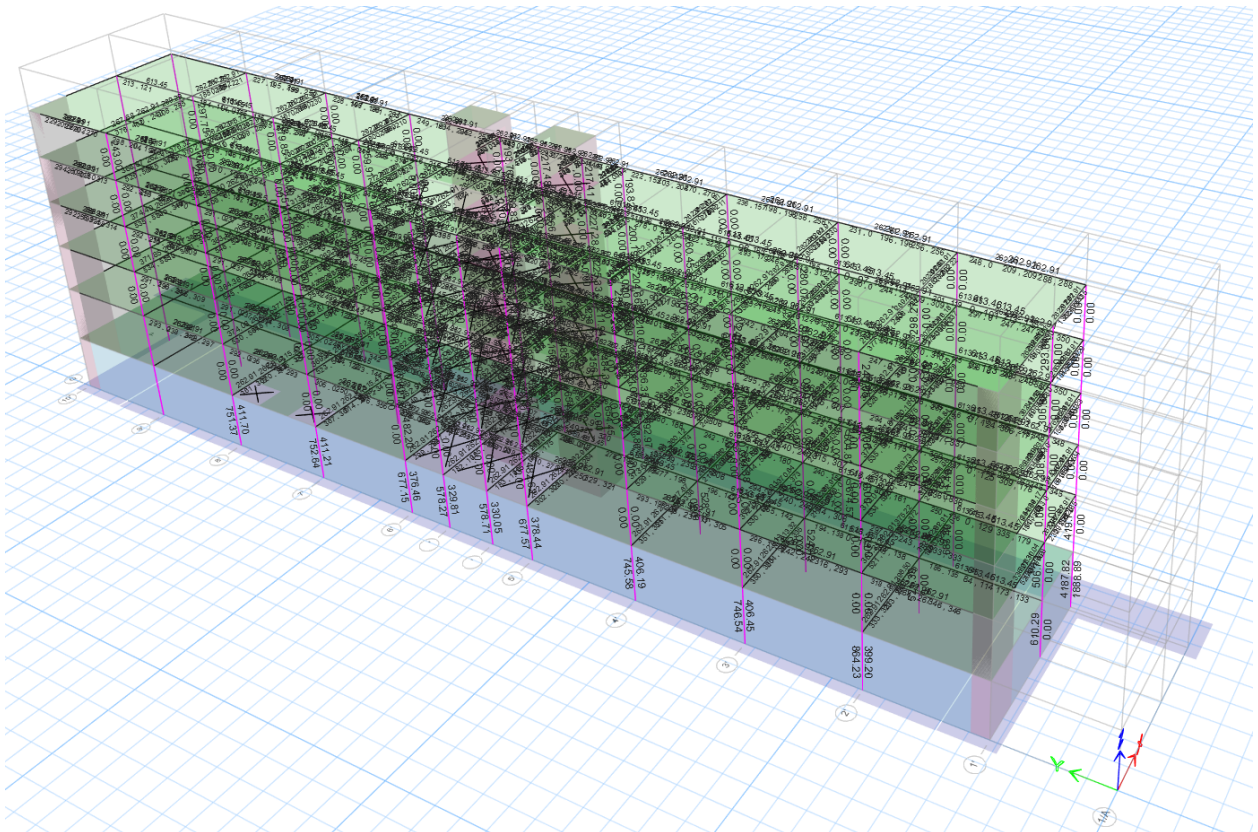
Sipërfaqja e armimit të stafave për kolonat [mm^2/mm], ndërtesa e hotelit
